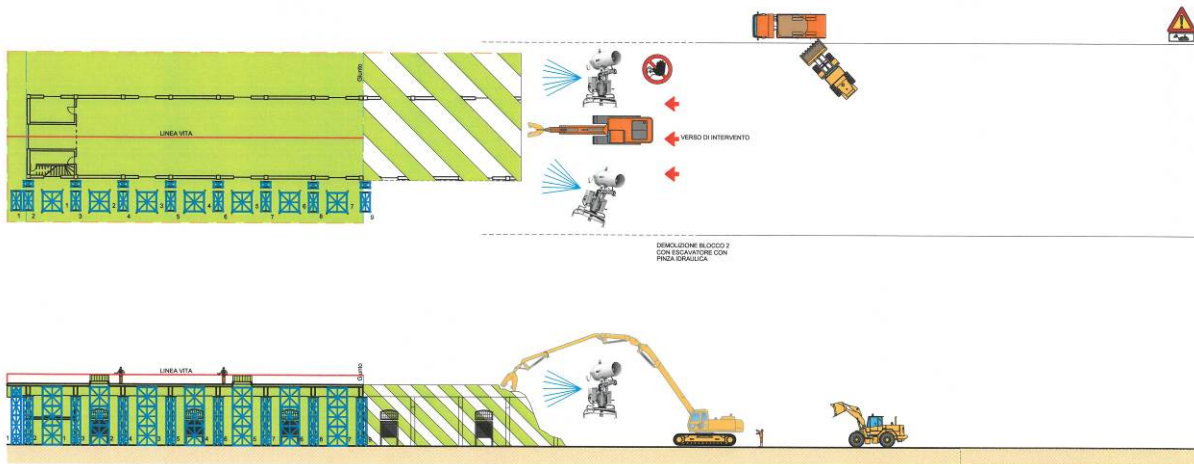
Planimetria e vista longitudinale Demolizione Edificio A9 – Demolizione con pinza idraulica
